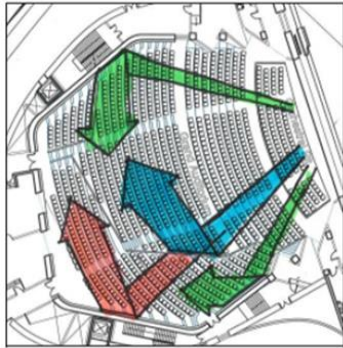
توضح مسقط أفقي للطابق الاول للقاعة
